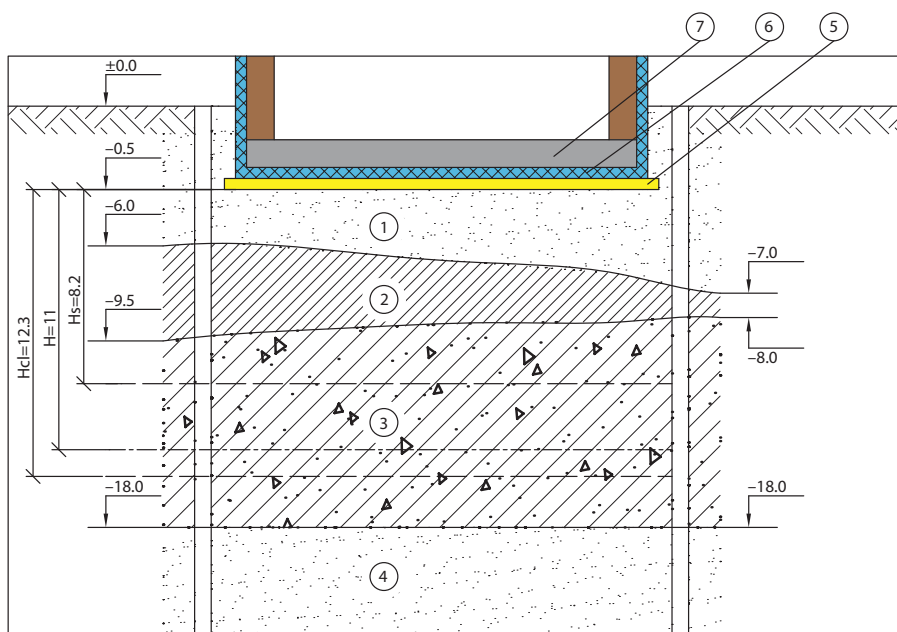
Геологический разрез и фундаментная плита поверх теплоизоляции STYROFOAM GEO
